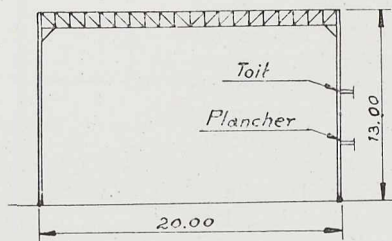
Portique transversal de la grande salle; la béquille de droite supporte également le plancher de la toiture du foyer.
